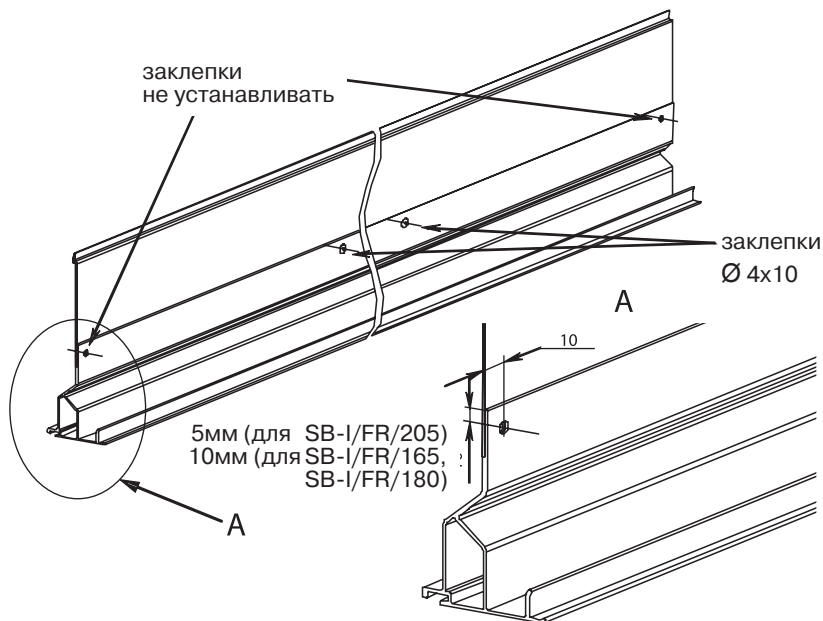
Схема крепления наружной крышки короба и шины фасадной
